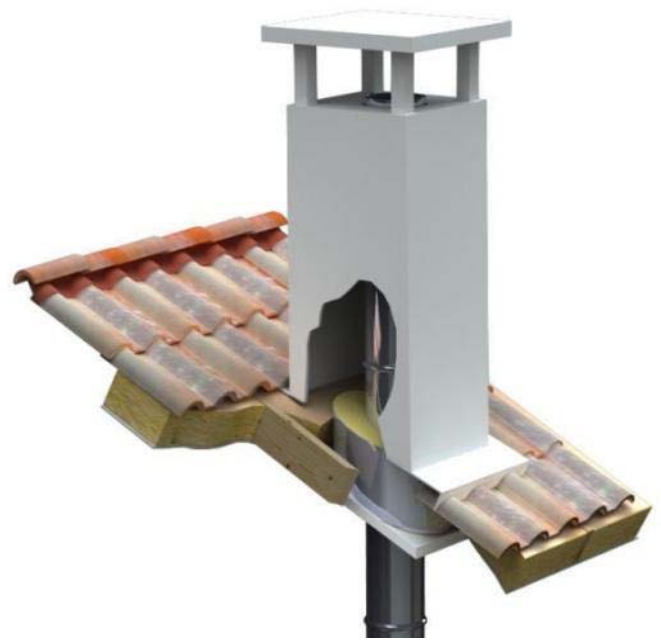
« Kit isolé » pour plain-pied plafond rampant
